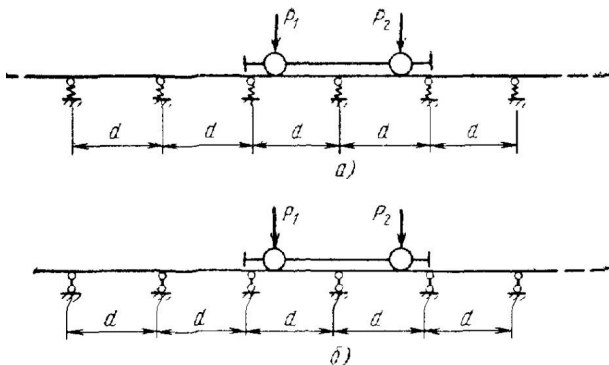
Розрахункові схеми їздової балки на опорах:
